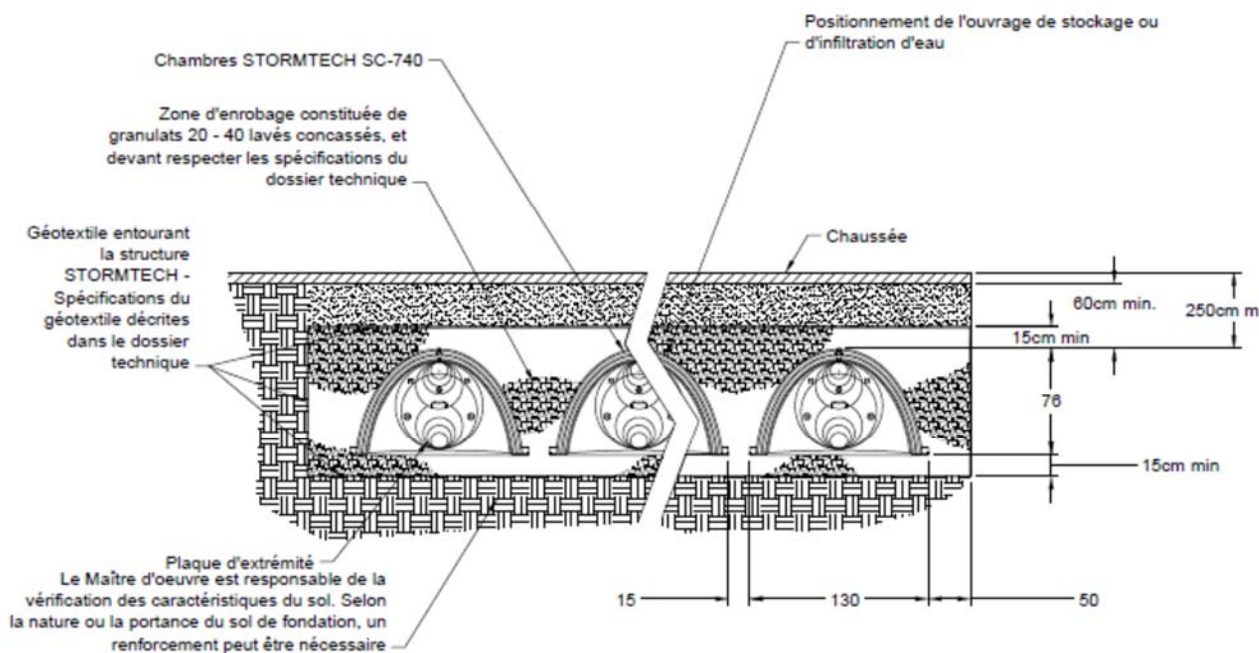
Plan en coupe de l'installation avec ou sans charge roulante (Chambres STORMTECH SC310 + STORMTECH SC-740)
